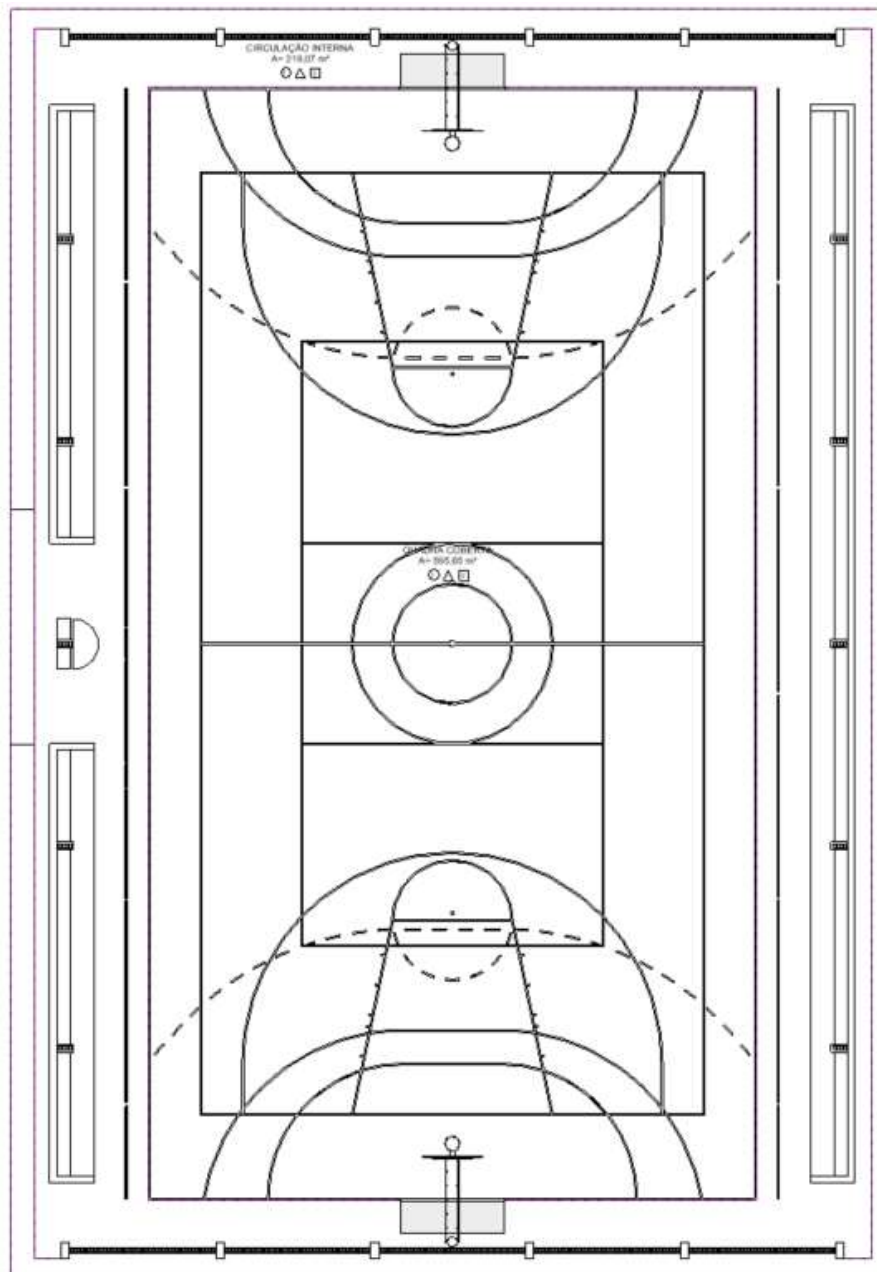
Planta Baixa de Implantação – Bloco G (Quadra coberta)
